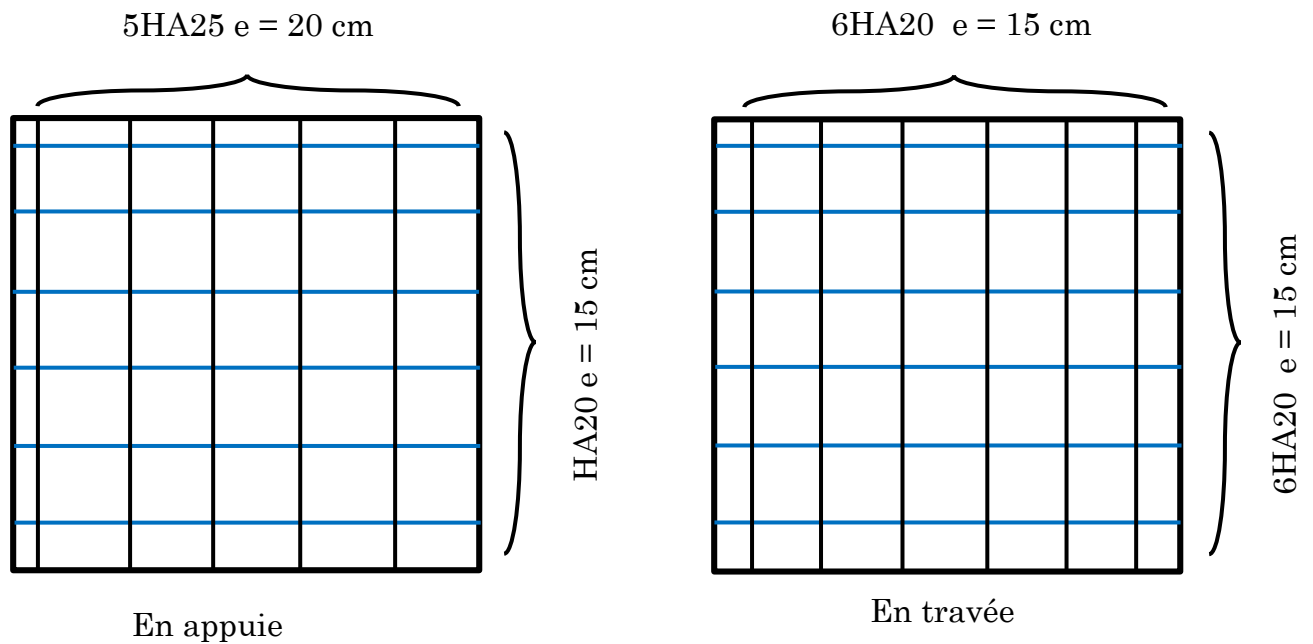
Schéma de ferrailage de la dalle du radier.
